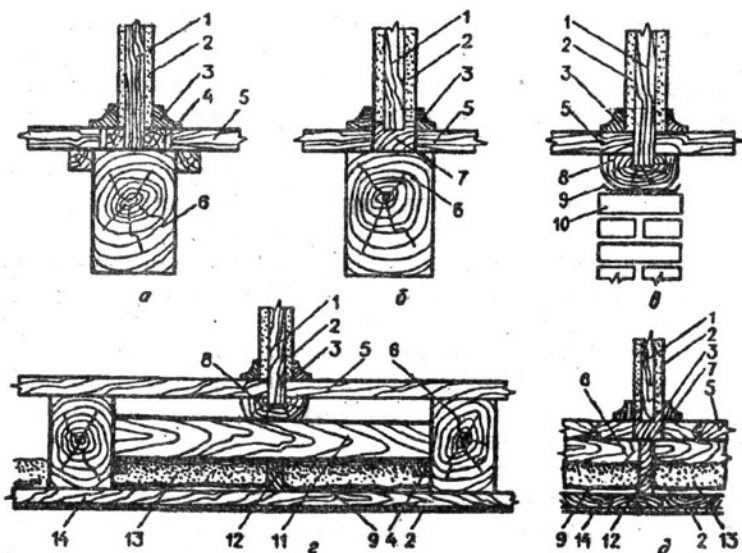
Опираание перегородок при размещении их вдоль балок (а... г) и поперек (д):
